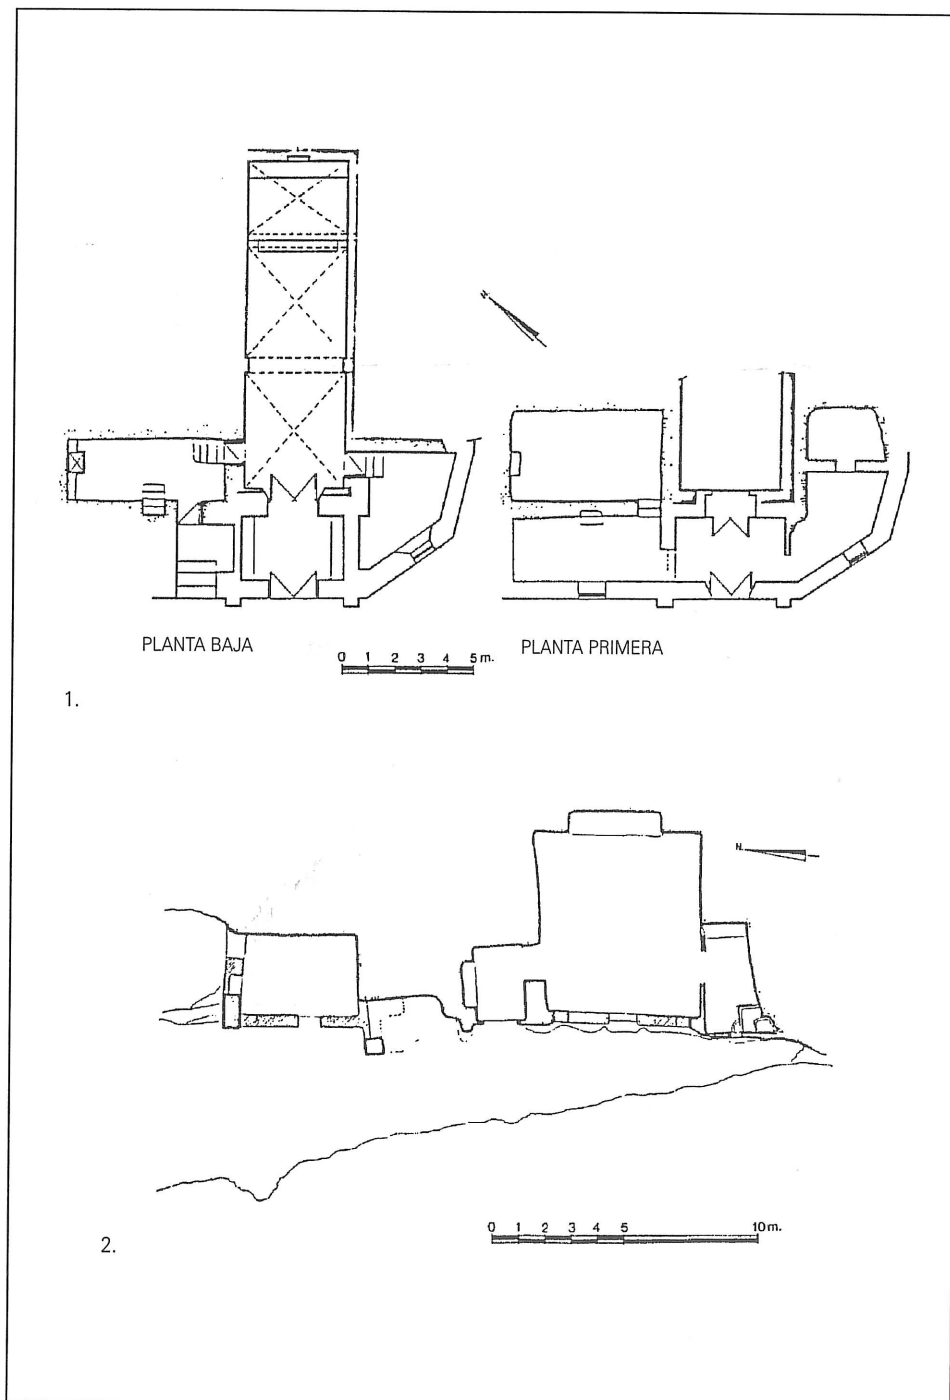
1. Ermita de la Fuensanta. Pizarra (Málaga). Planta (según: Puertas Tricas). 2. Iglesia rupestre. Villanueva de Algaidas (Málaga). Planta (según: Puertas Tricas)
